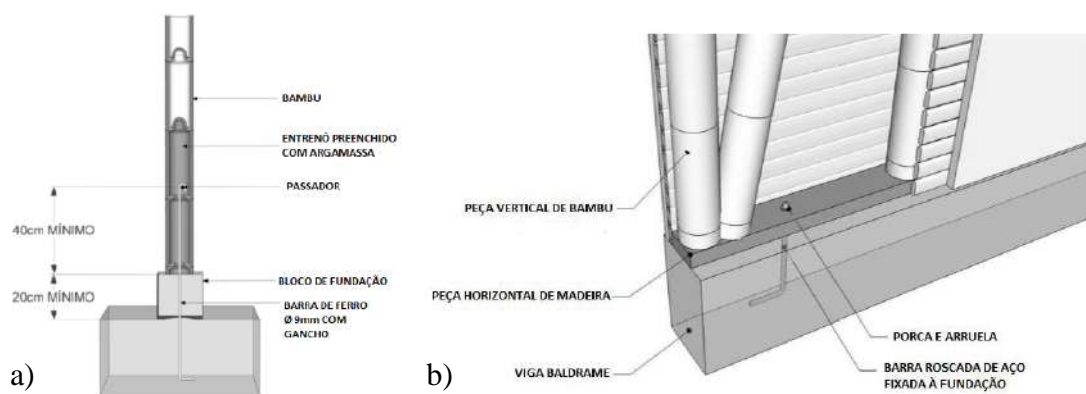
a) Representação do estudo de fundações. b) Fixação da peça pré-fabricada e a viga da fundação.
